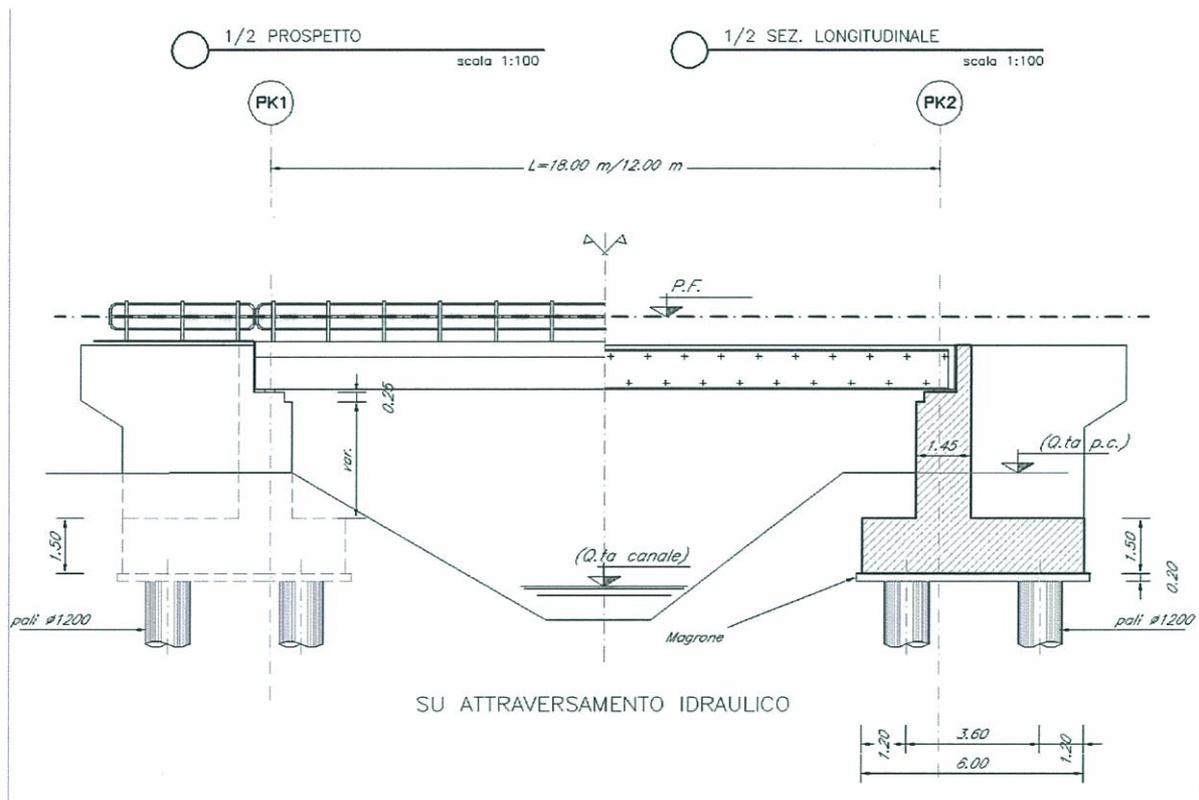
Prospetto/Sezione longitudinale in corrispondenza di attraversamento idraulico.
